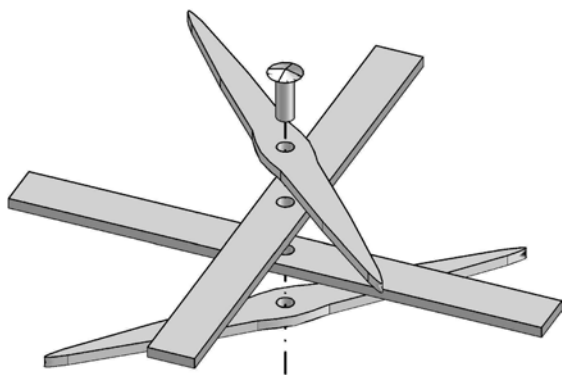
Konstruktionsschema Fenstergitter Typ IIB3.
